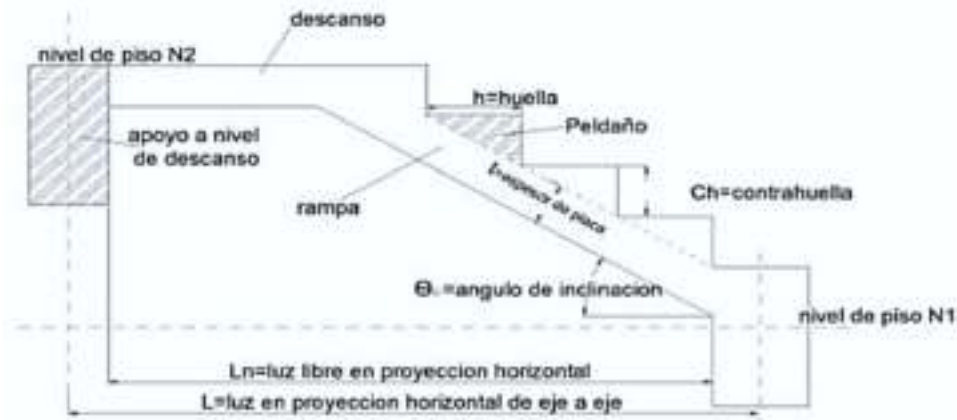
Partes de una escalera típica de Hormigón Armado
